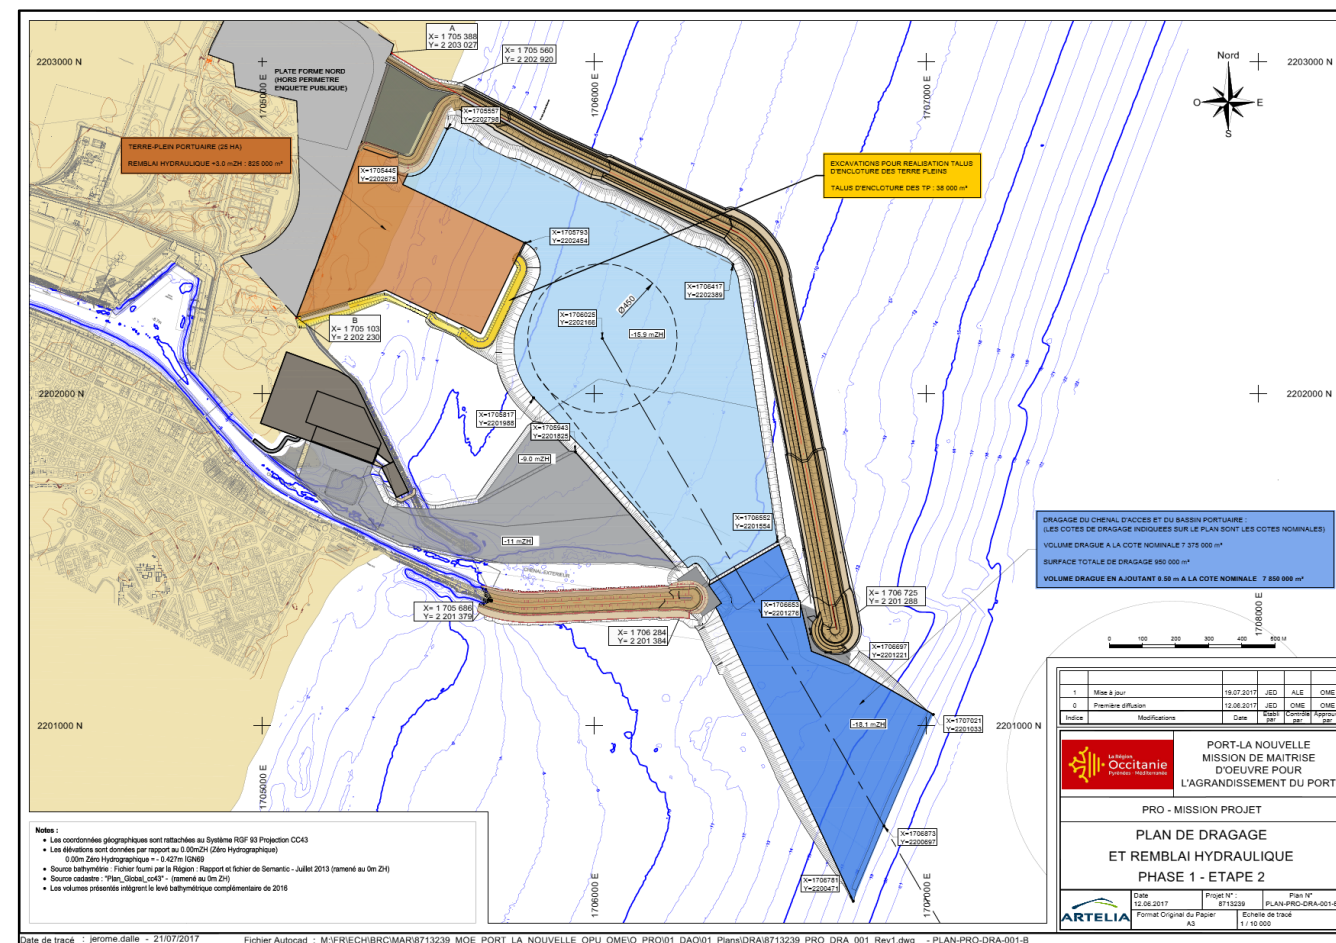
Plan de dragage et remblai hydraulique – Etape 2
